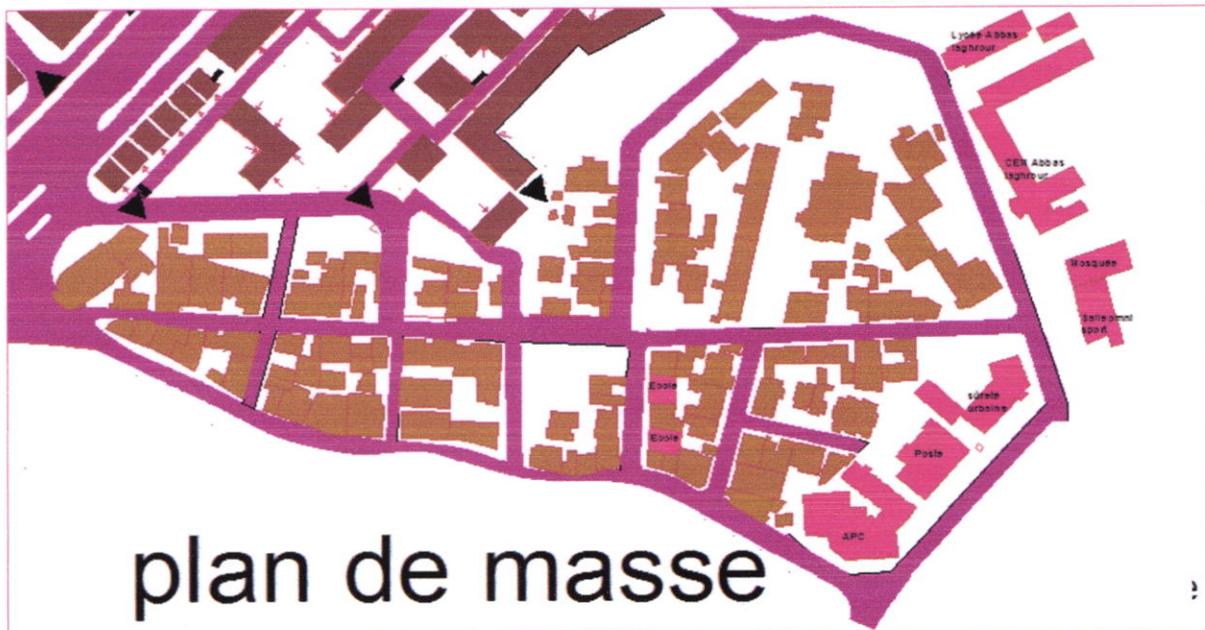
Plan de masse (l'état actuel d'aire d'intervention)
